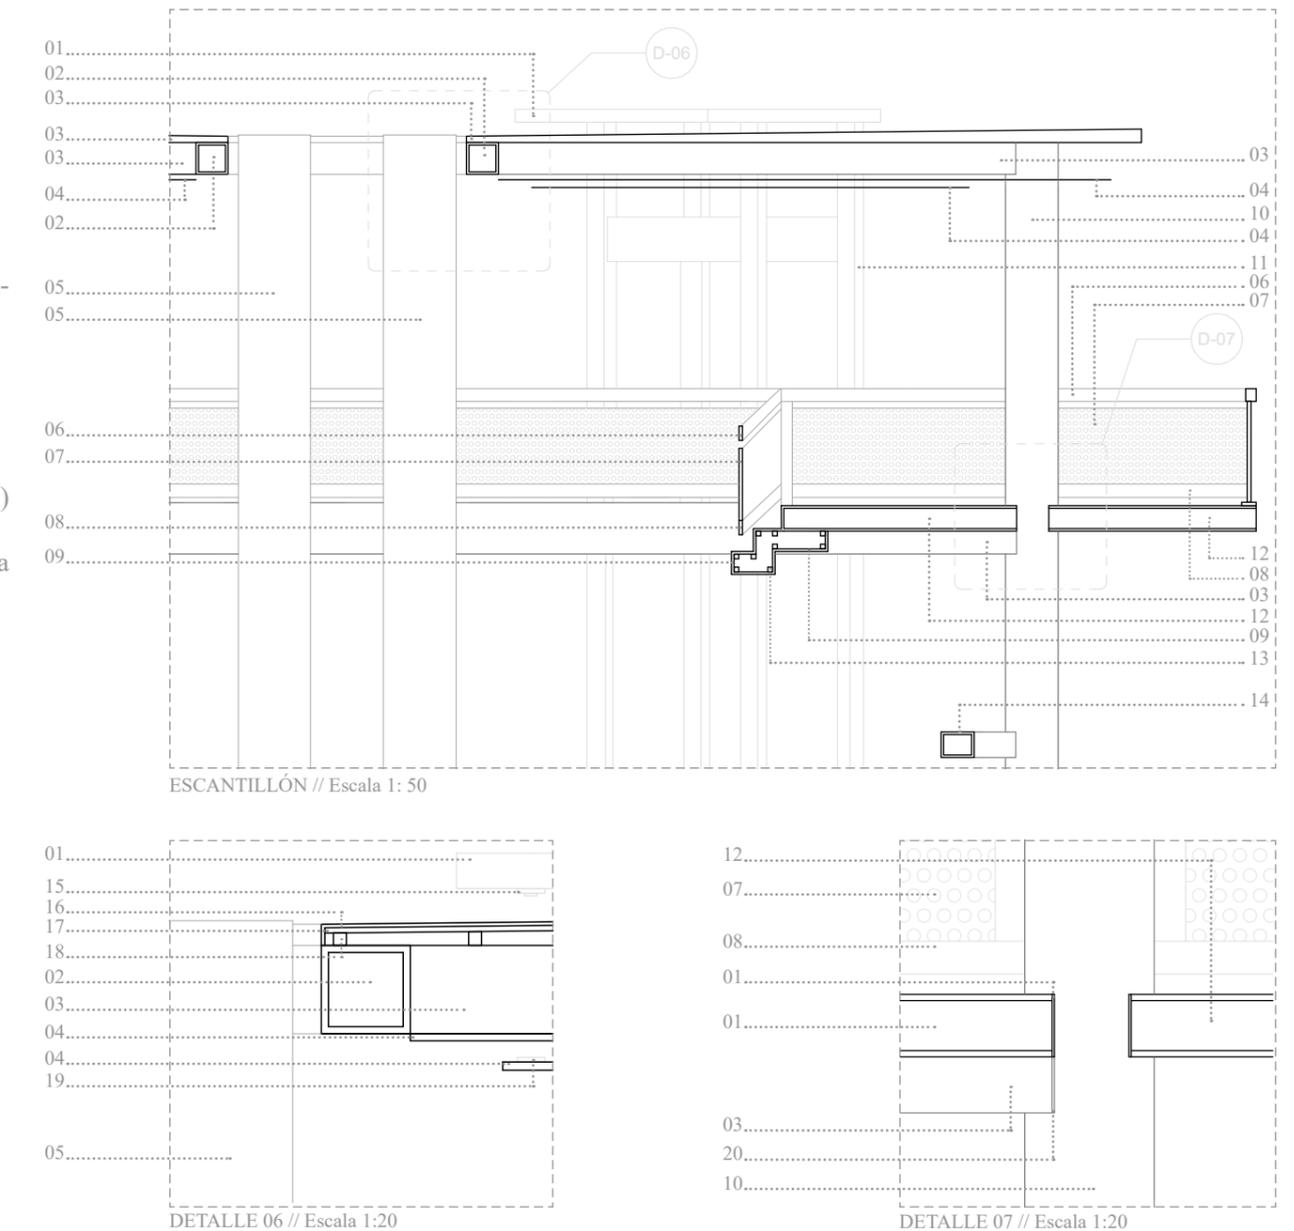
Detalles constructivos de equipamiento (Autor, 2021)
